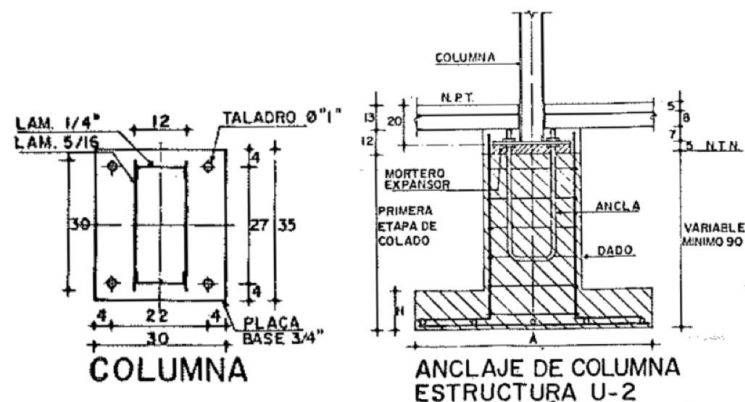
Columnas y anclaje a cimentación.
